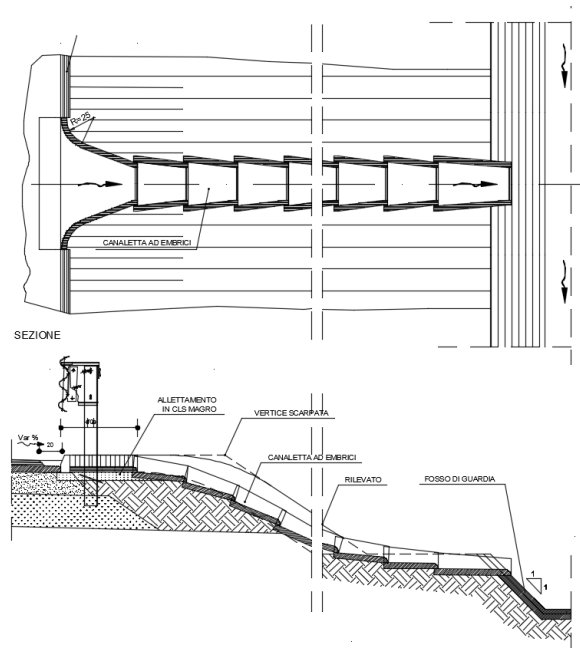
Dettaglio embrice per sezione tipo in rilevato
